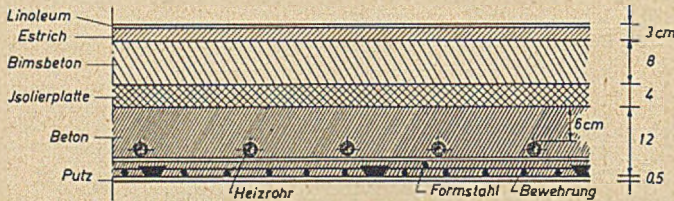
Vollbetondecke zum Berechnungsbeispiel.
